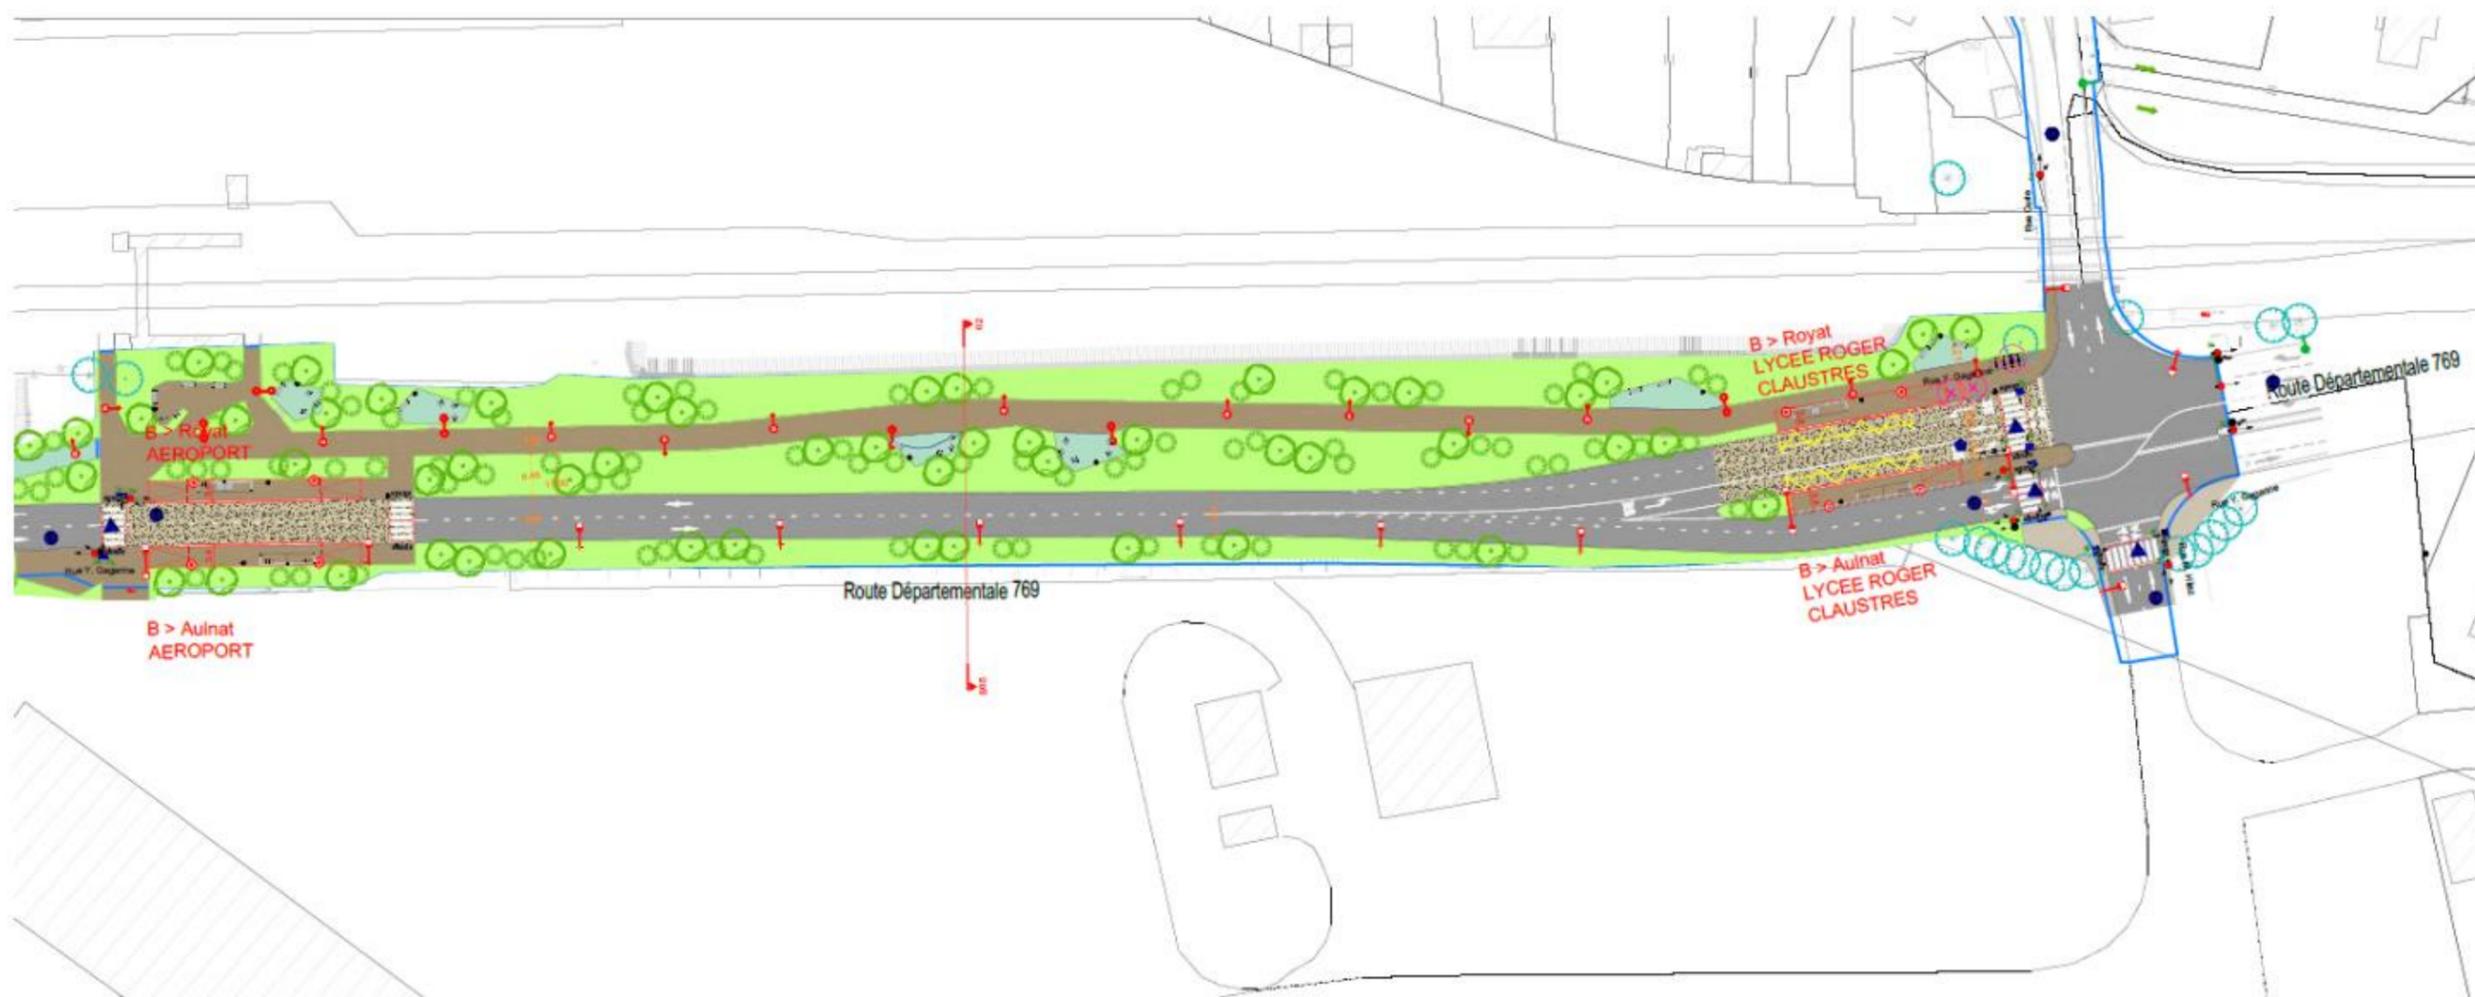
Plan d'aménagement paysager de la façade urbaine de l'aéroport
